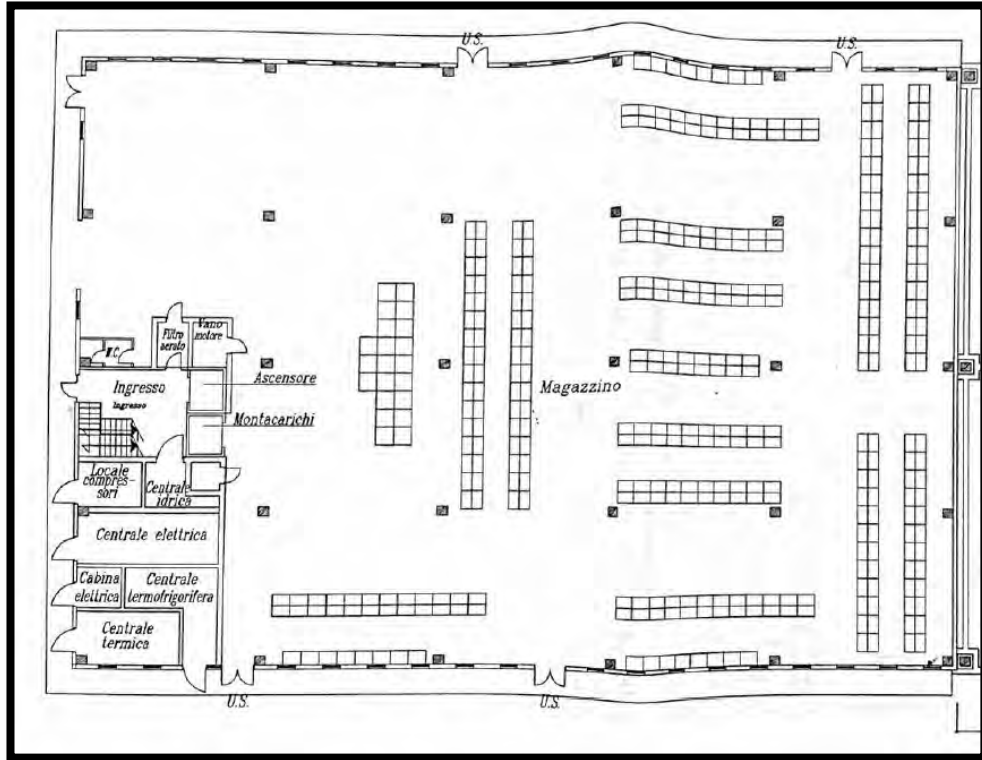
Pianta piano seminterrato allegata alla DIA n. 8751 del 05/12/2006
